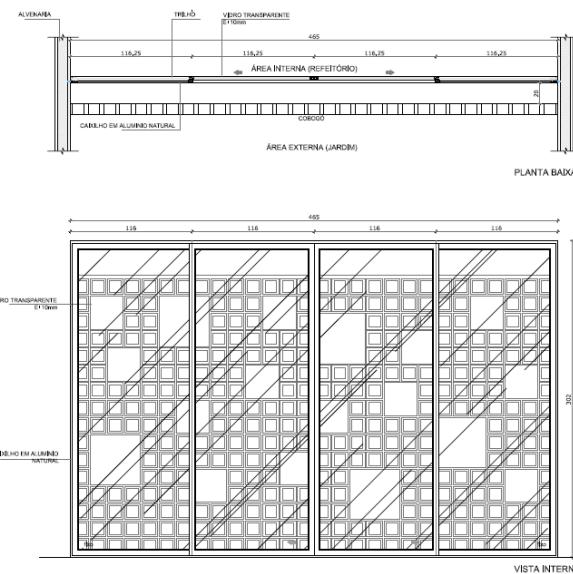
planta baixa e vista do fechamento do pátio coberto da escola infantil tipo C.
